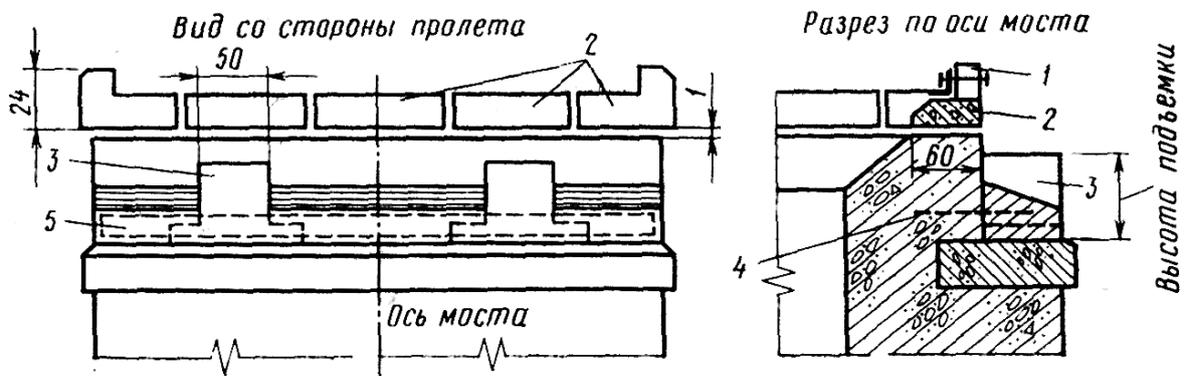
Наращивание подферменной площадки железобетонными блоками:
